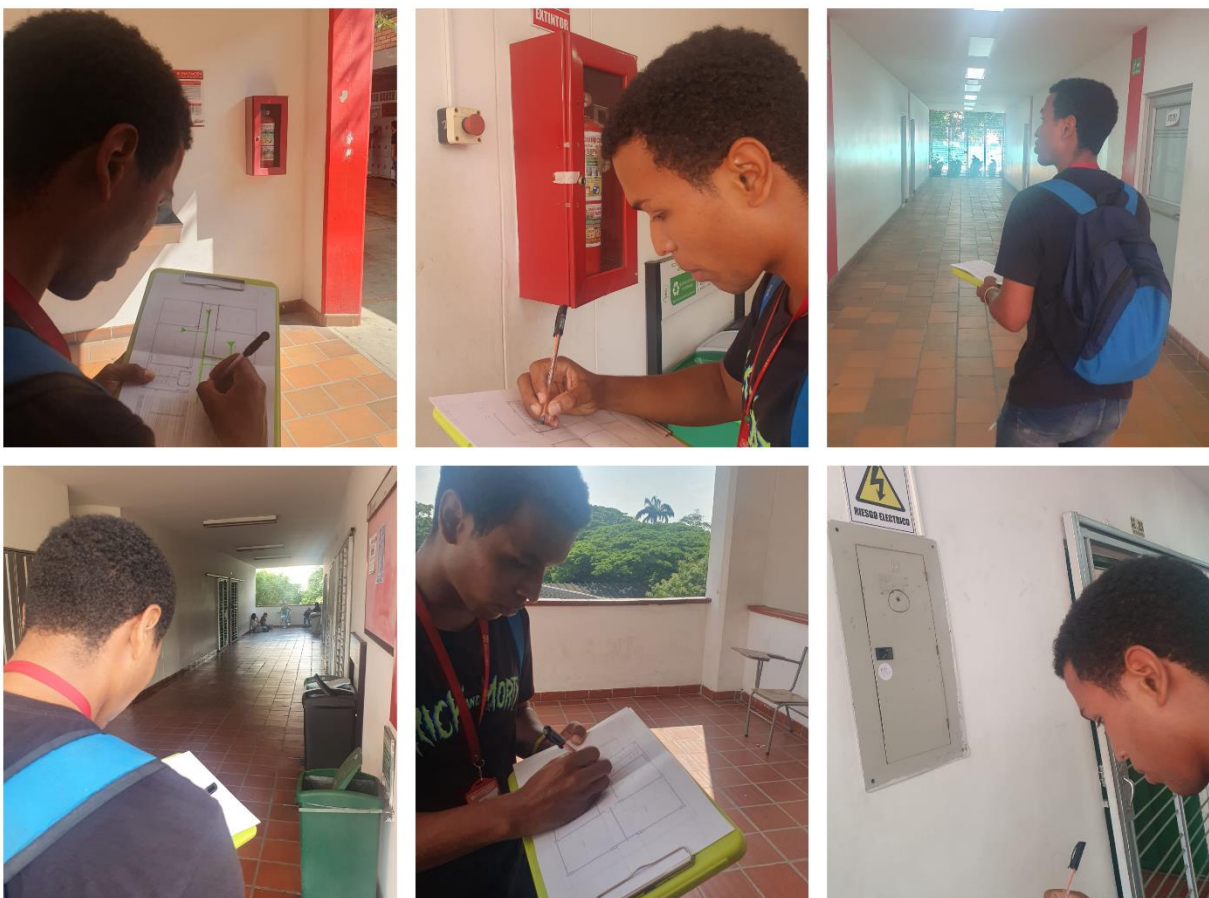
Visita de inspección, edificio Aulas Generales. Fuente: Elaboración propia.
